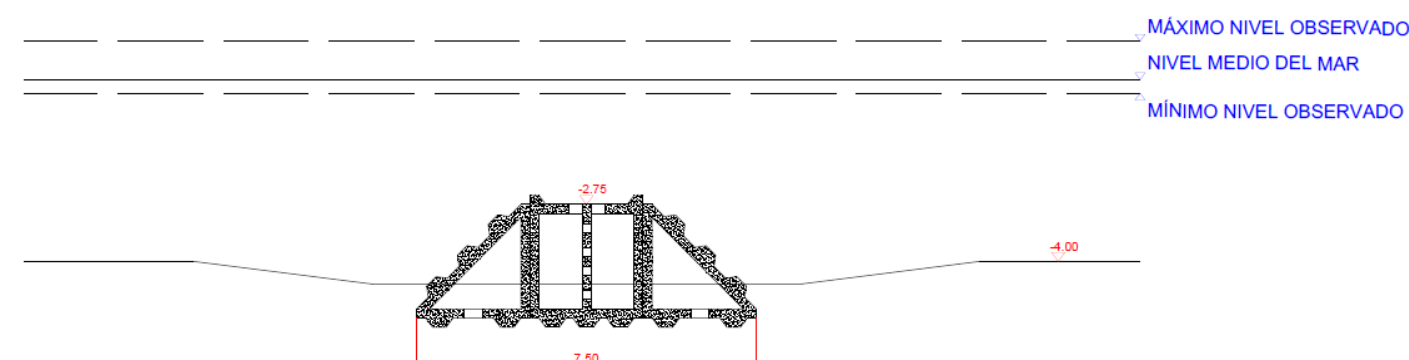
Prediseño de configuración TCT con estructuras modulares. (Fuente: plano 6, 2023).
